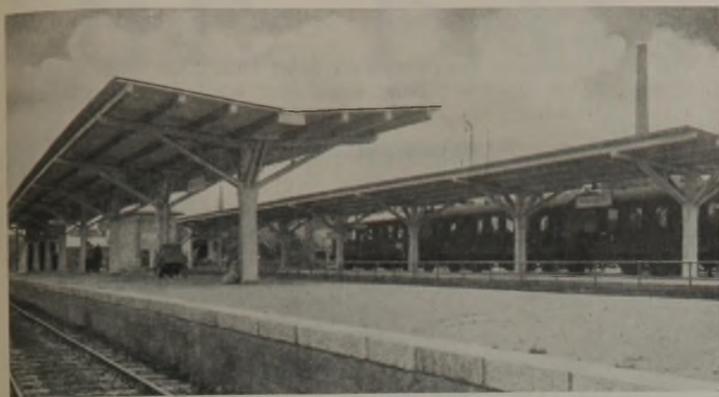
Einstielige Bahnsteig-Überdachung auf Bahnhof Bedburg, Ert.
